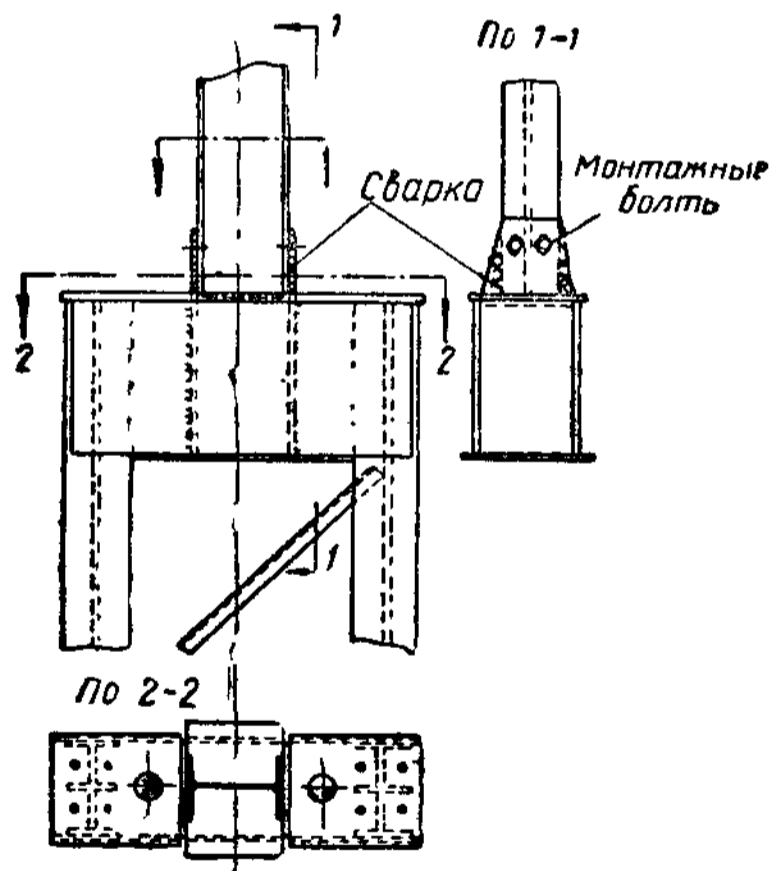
Укрупнительный стык ступенчатой колонны на сварке
